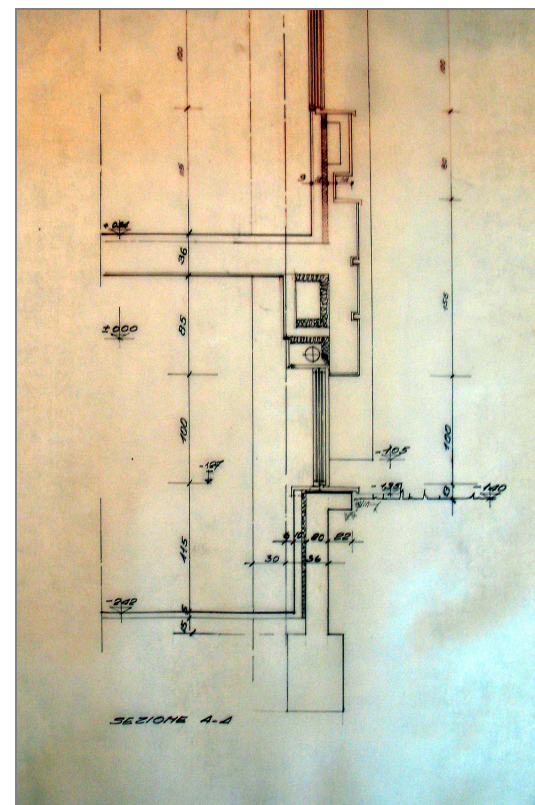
sezione corpo A – piano terra (fonte CSAC – stralcio tav. 37, archivio n. 400-1)
